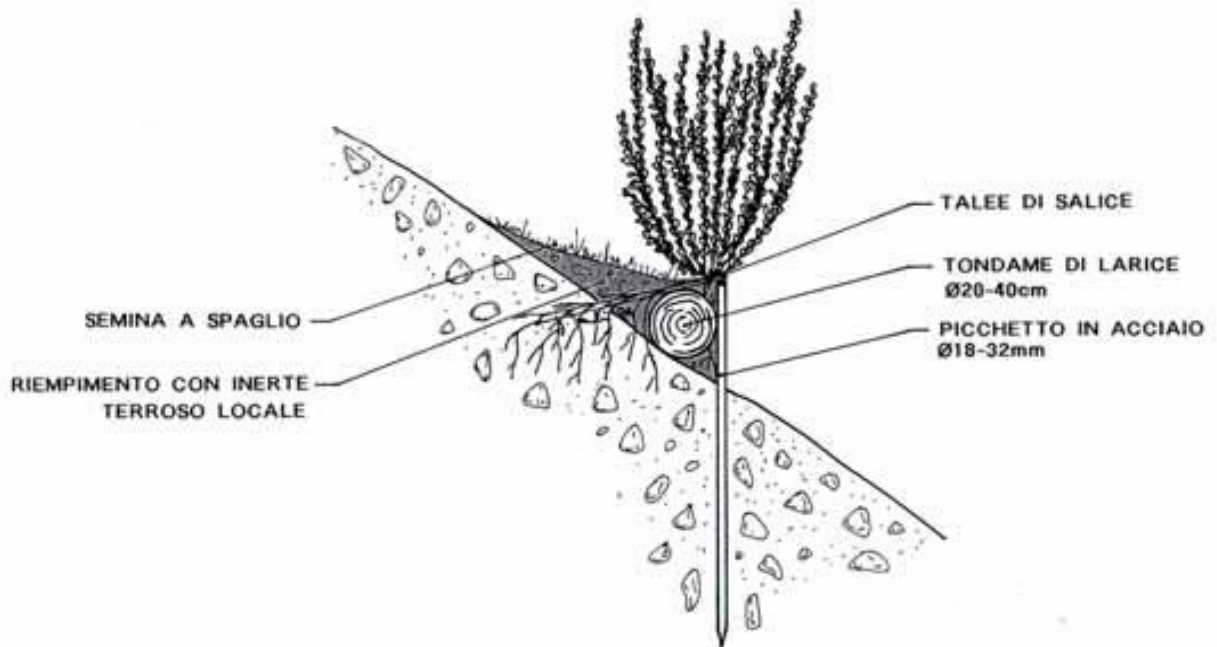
Sezione tipo di palizzata viva ad un palo.
